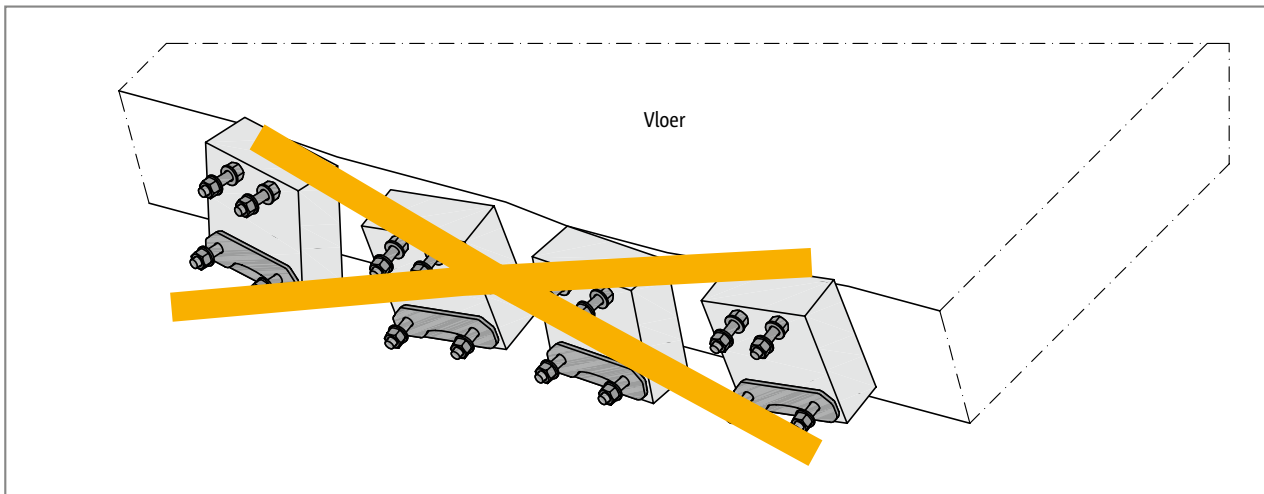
Schöck Isokorb® T type SK: Plaatsing met hoogteverschil
